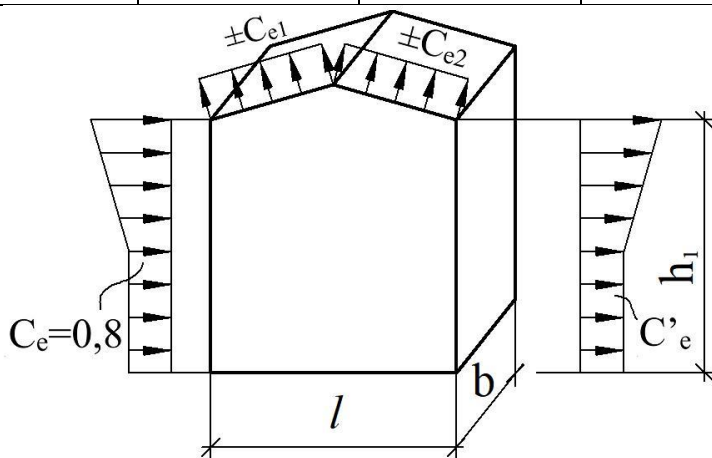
Схема вітрового навантаження на поверхню будівлі.
